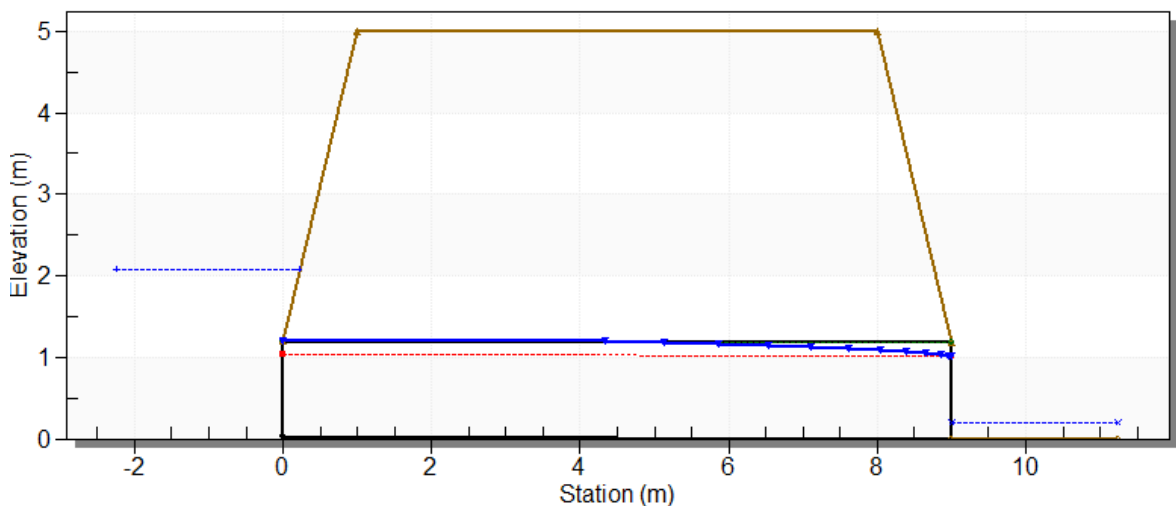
Desing Culvert. Metal corrugado 1200 mm
